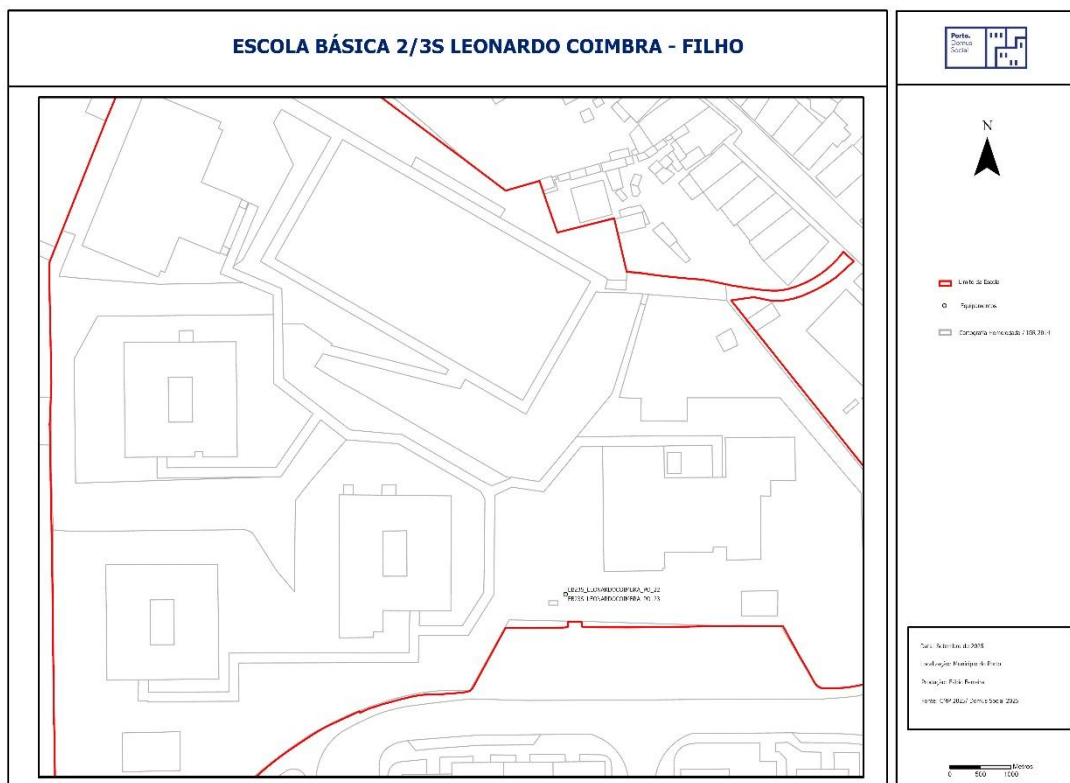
Planta do cadastro do espaço exterior da Escola Básica 2/3S Leonardo Coimbra - Filho
